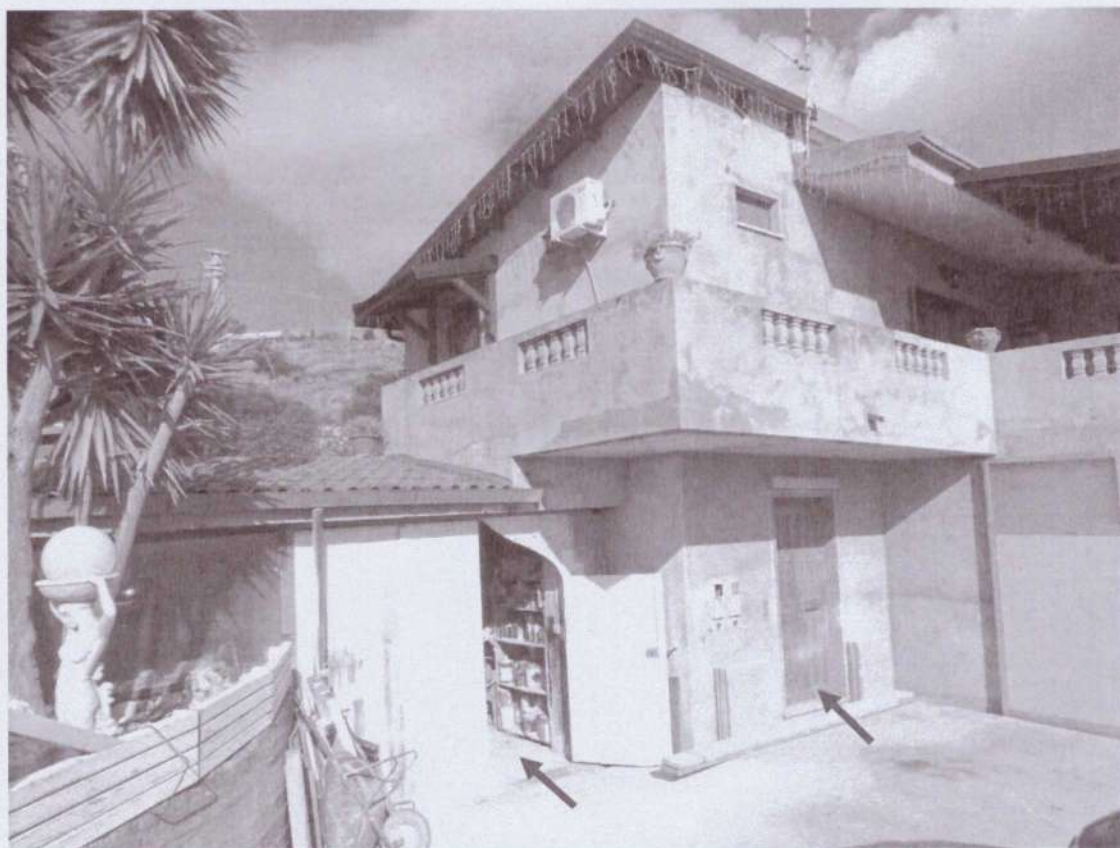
Piano terra – Piazzale e accesso al deposito - verniciatura e deposito-laboratorio
